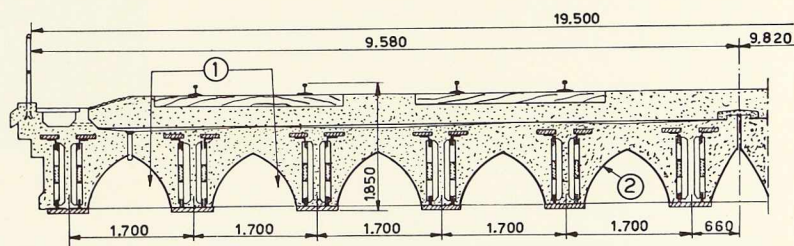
Pont de Thionville-Sud. Coupe transversale.
